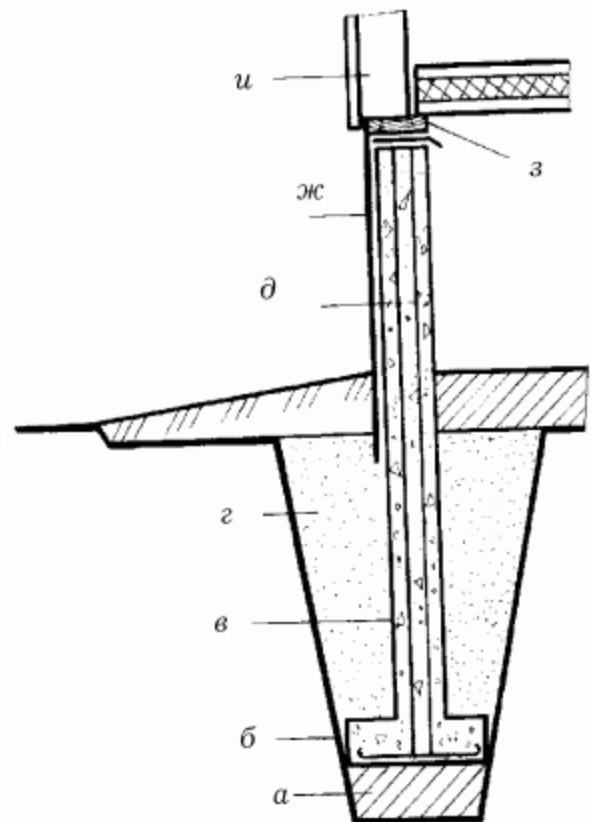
Устройство столбчатых фундаментов из асбестоцементных труб: а – уплотненный грунт; б – железобетонный анкер; в – асбестоцементная труба; г – обратная засыпка; д – арматура; ж – забирка из асбестоцементного листа; з – доска-подкладка; и – деревянная стена.
